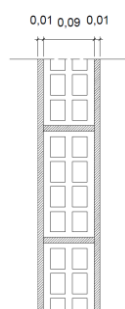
parede simples em tijolo cerâmico vazado de 9 cm
